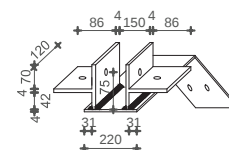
Detaji i mbërthimit të tirantave me mahitë dhe kreun prej murature të armuar
